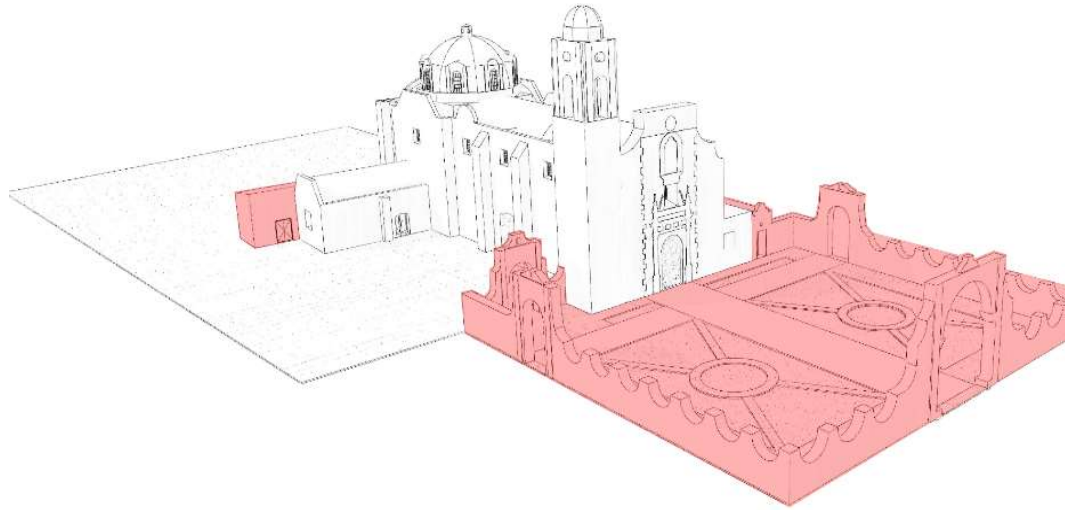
Quinta etapa constructiva. Autor: SLF
